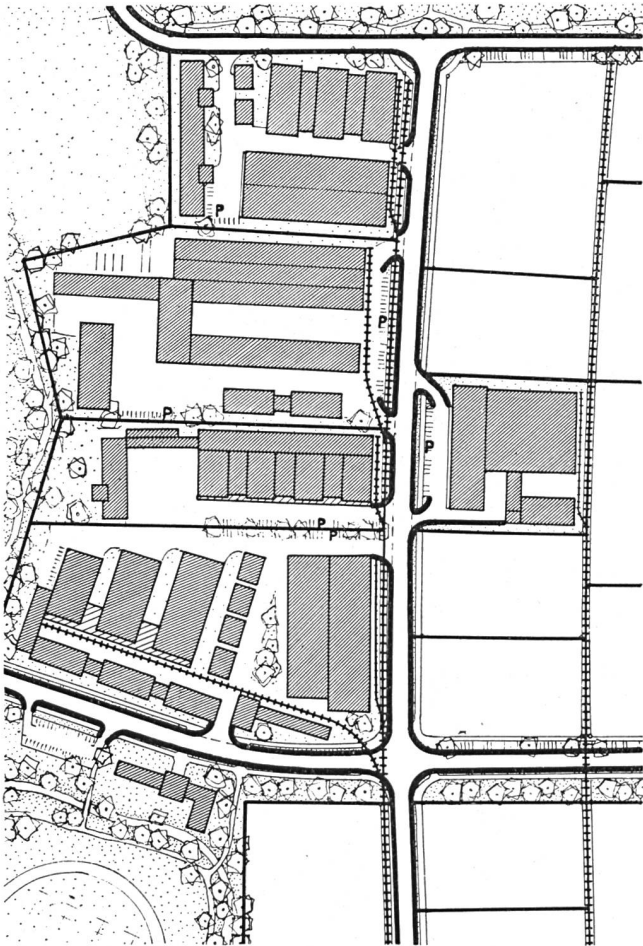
Schemaplan der möglichen Parzellierung und Ueberbauung mit Erschliessung durch Strassen und Industriegeleise.
